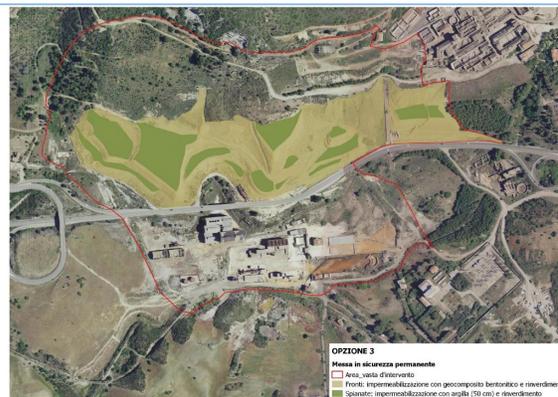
Planimetria degli interventi dell'opzione progettuale n. 3
